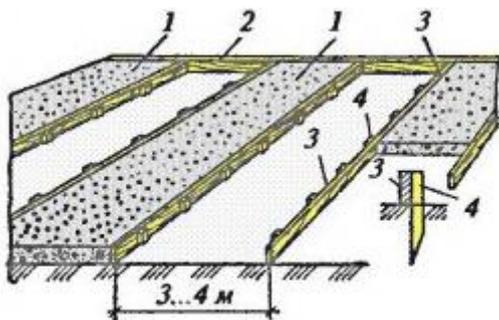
Бетонування підлог: карта –1; поперечна дошка –2; направляюча дошка – 3; кріплення –4
